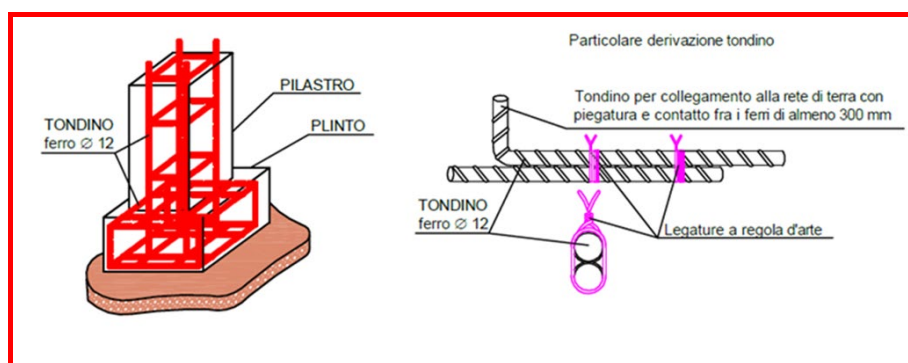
Esempi di plinti di pilastri e di connessioni ai ferri dell'armatura
